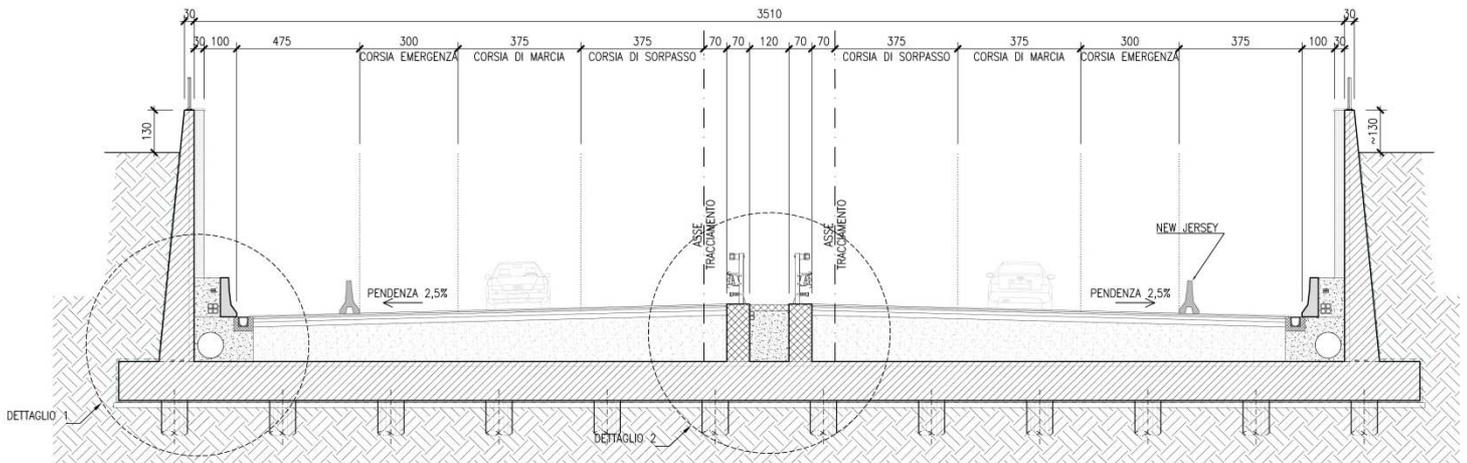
SEZIONE TIPICA TRINCEA
